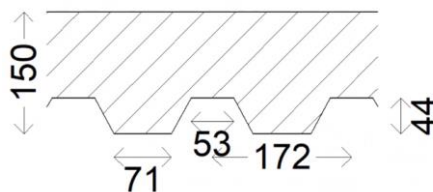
Losa mixta EUROMODUL44 en forma de u
